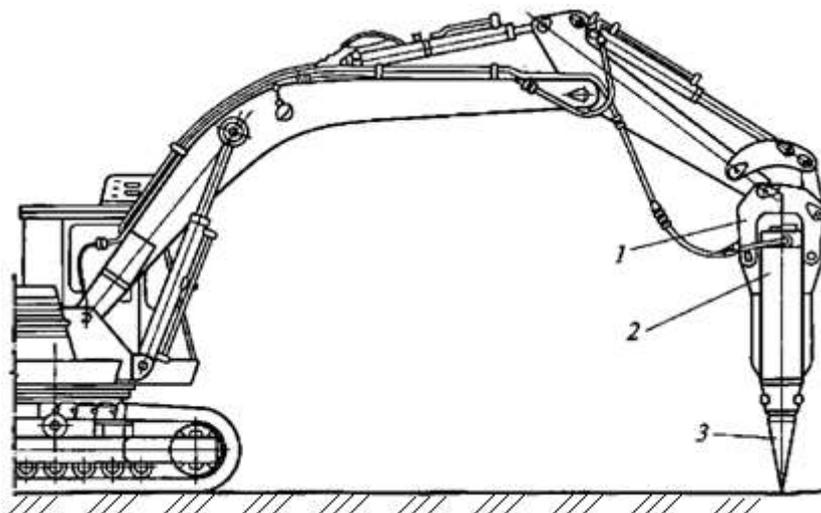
Одноковшовый гидравлический экскаватор с рабочим оборудованием гидромолота.
